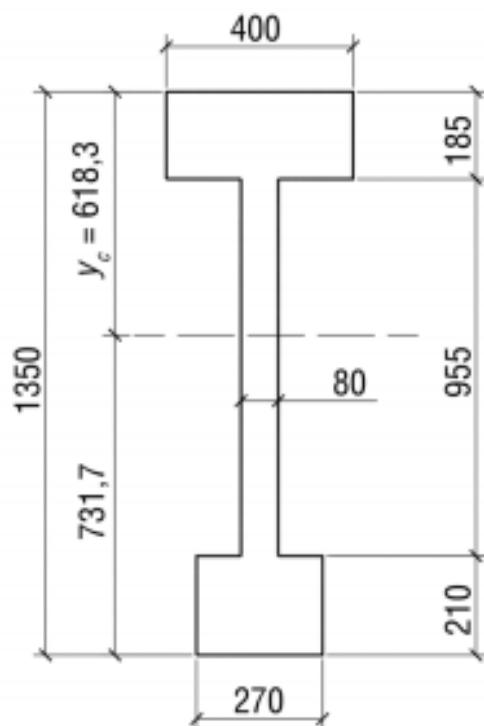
Расчетное сечение балки (сечение x-x по рис. 1)
